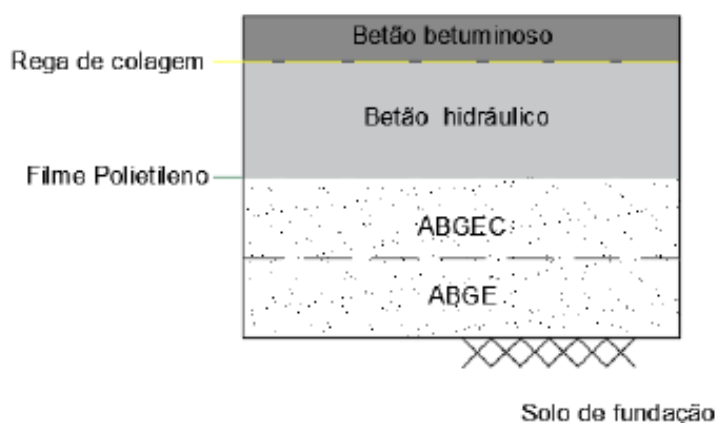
Camadas constituintes de um pavimento semirrígido [10].
